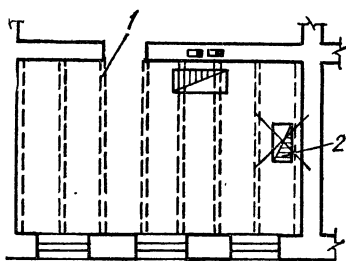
Правильное и неправильное размещение печей на междуэтажном перекрытии:
